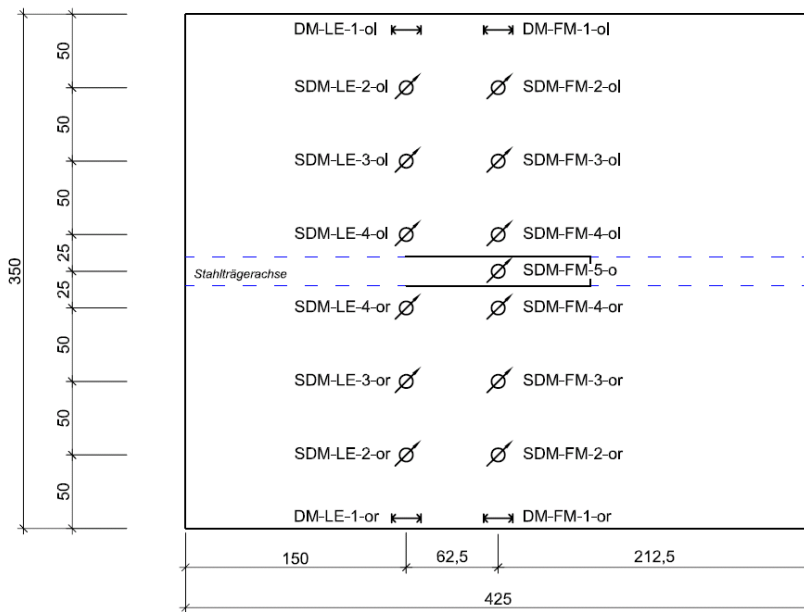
Betondehnmesser auf dem Betongurt (hier dargestellt: Draufsicht)
